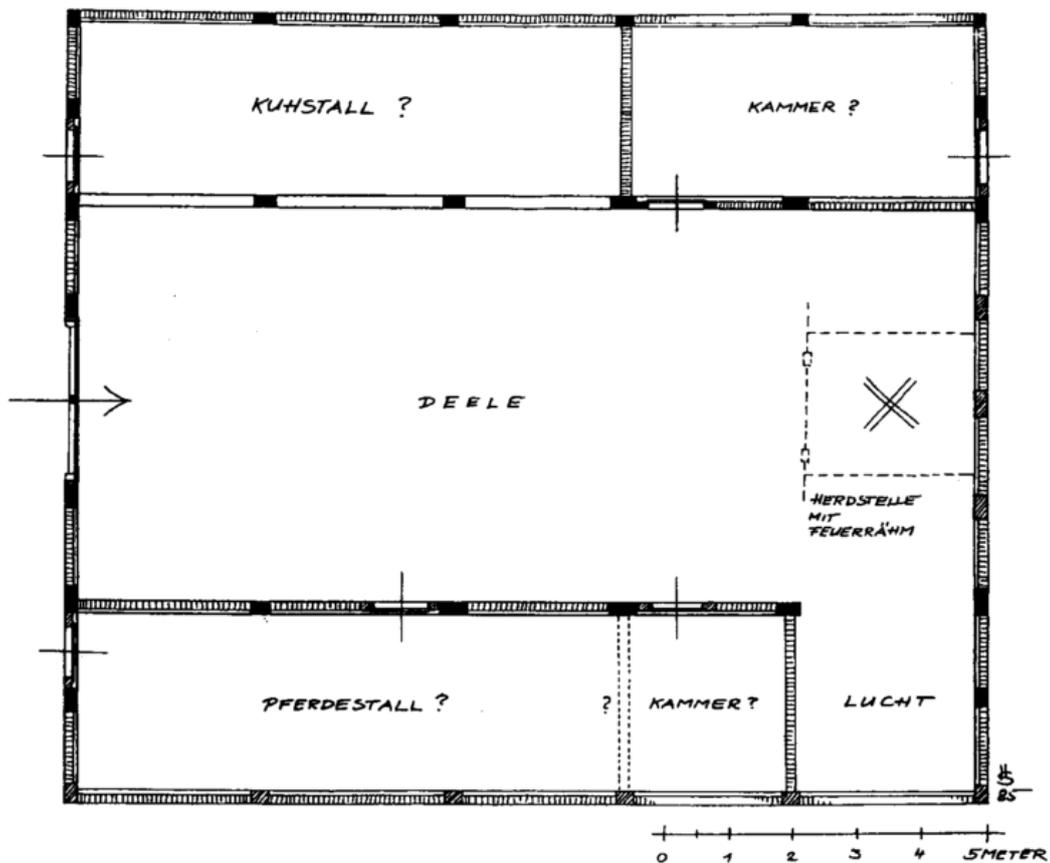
Schönemark (Stadt Detmold), ehem. Hof Klöpping Nr. 8. Bauernhaus (Großkötter), 1573 (i). Grundriss, rekonstruierter Zustand zur Bauzeit. Aufmaß und Zeichnung: Verf.
